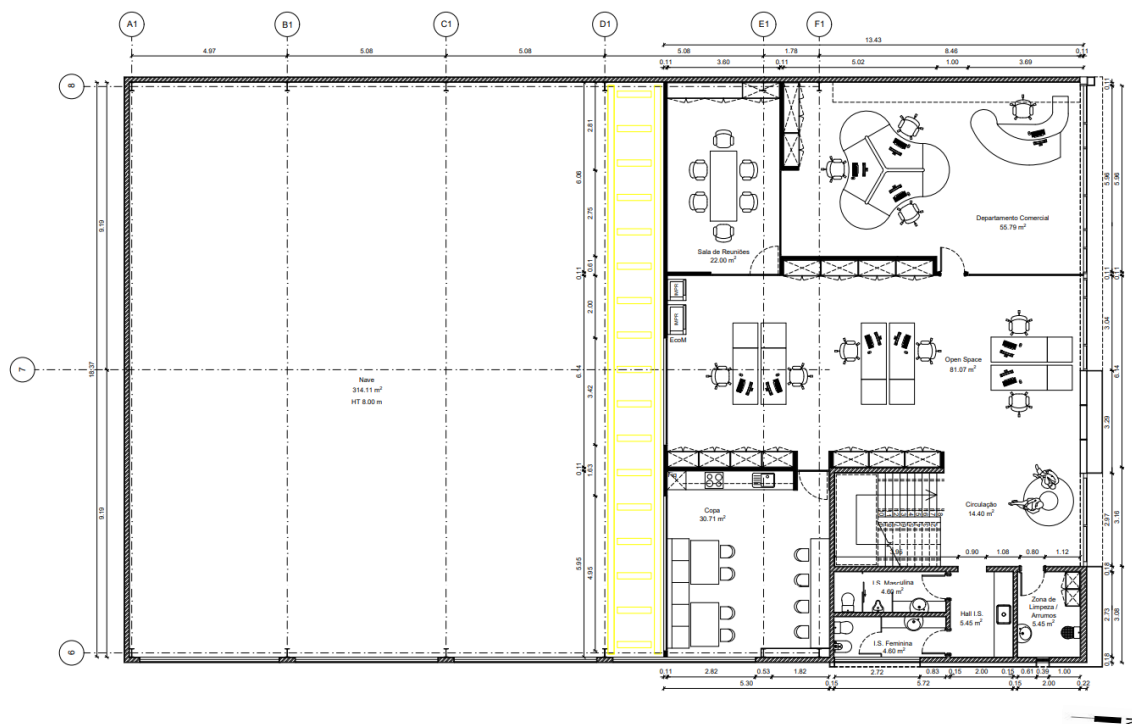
Proposto - Planta piso 1 (EP_R00). Fonte: Garq / Desenvolvimento: Autora.
